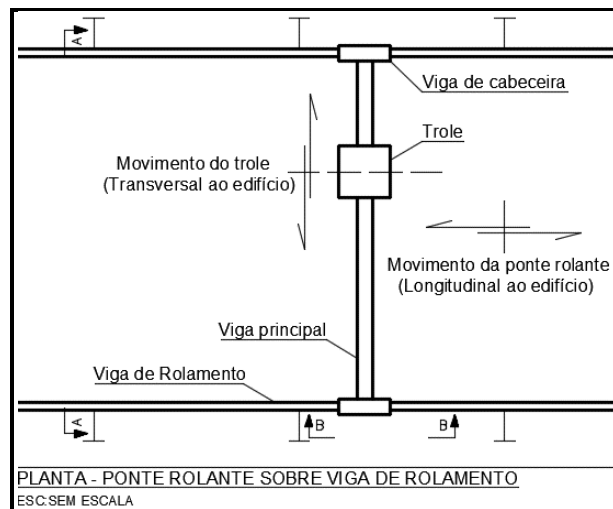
Vista em planta de ponte rolante com indicação de seus elementos.
